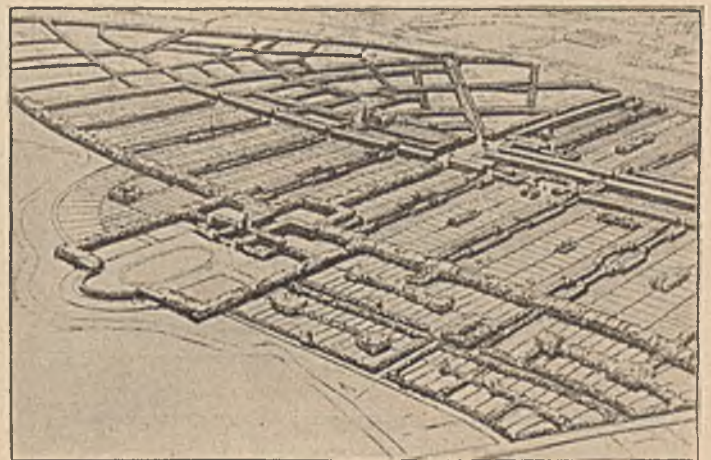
Ausschnitt aus dem Bebauungsplan von Breslau: Schaubild.
